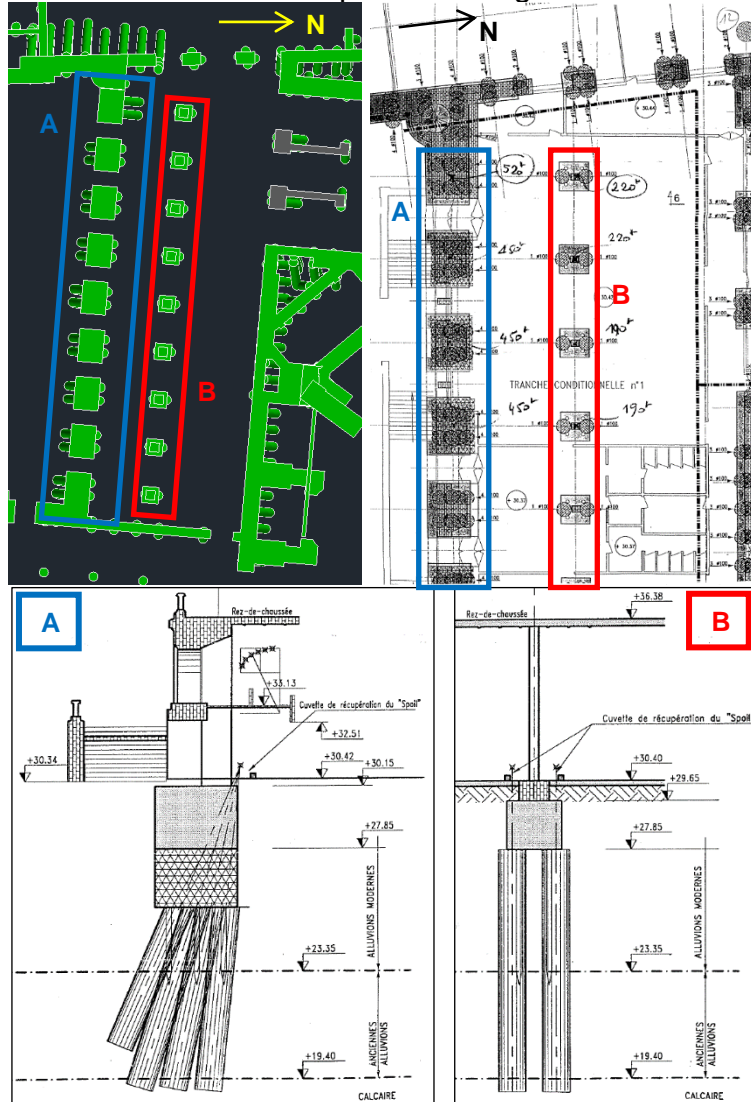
Vues en plan et coupes des files de fondations de la partie Ouest du BIS
